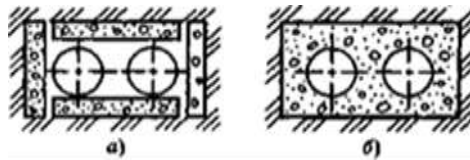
, Разрез бесканального теплопровода в литом пенобетонном массиве
